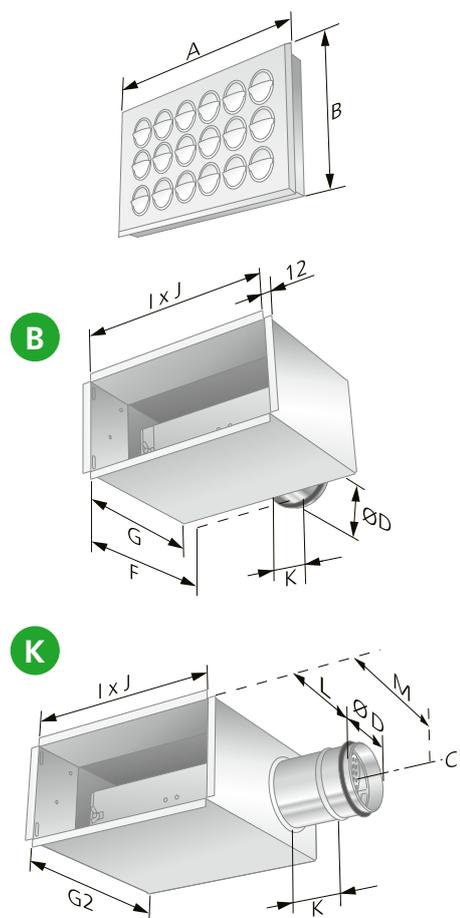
Abmessungen, COLIBRI Wall und Anschlusskasten ALV.
